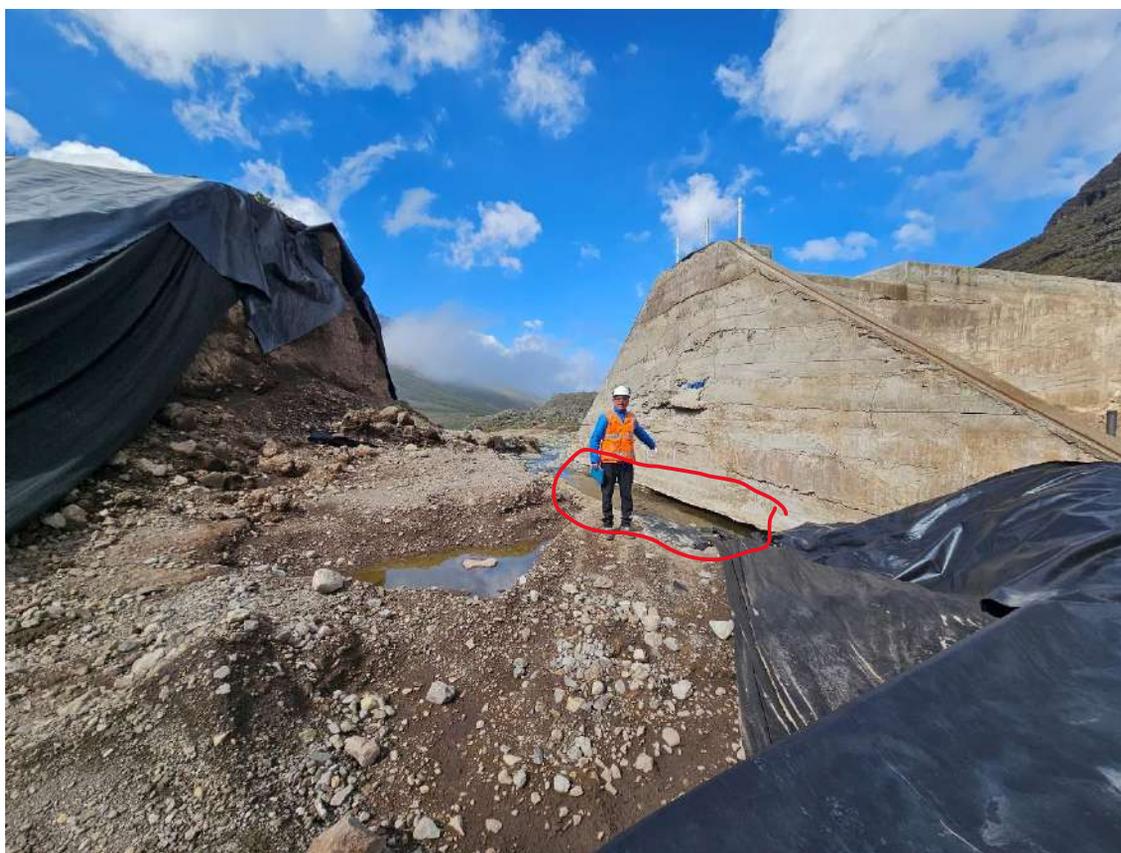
Cimentación colapsada por erosión del dique de concreto de la presa Yarcán.
